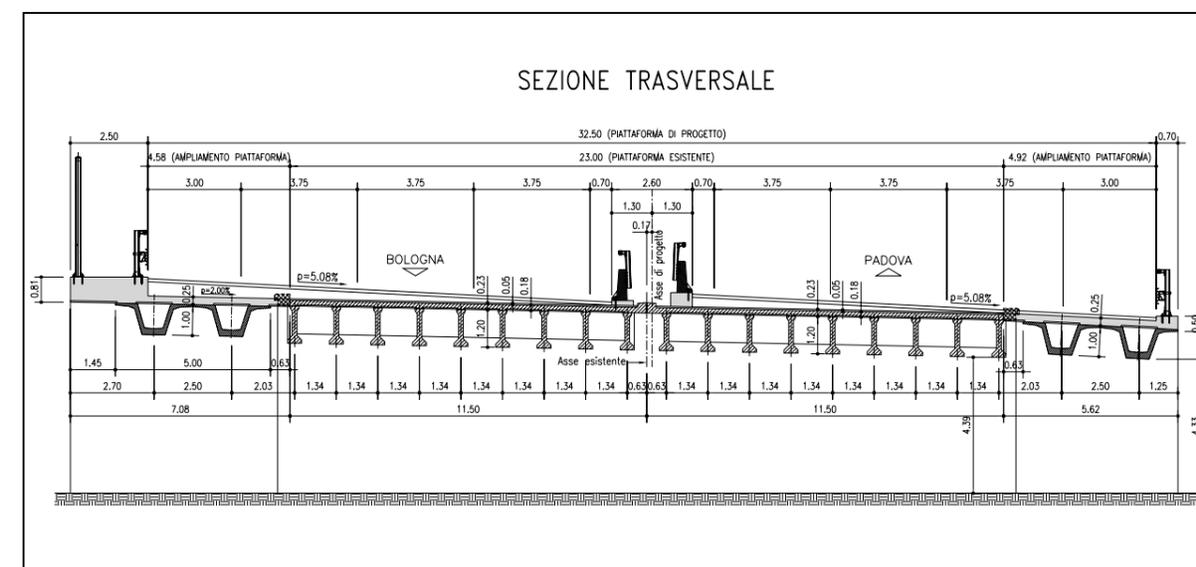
Sezione dell'impalcato e profilo del ponte sul canale Biancolino
